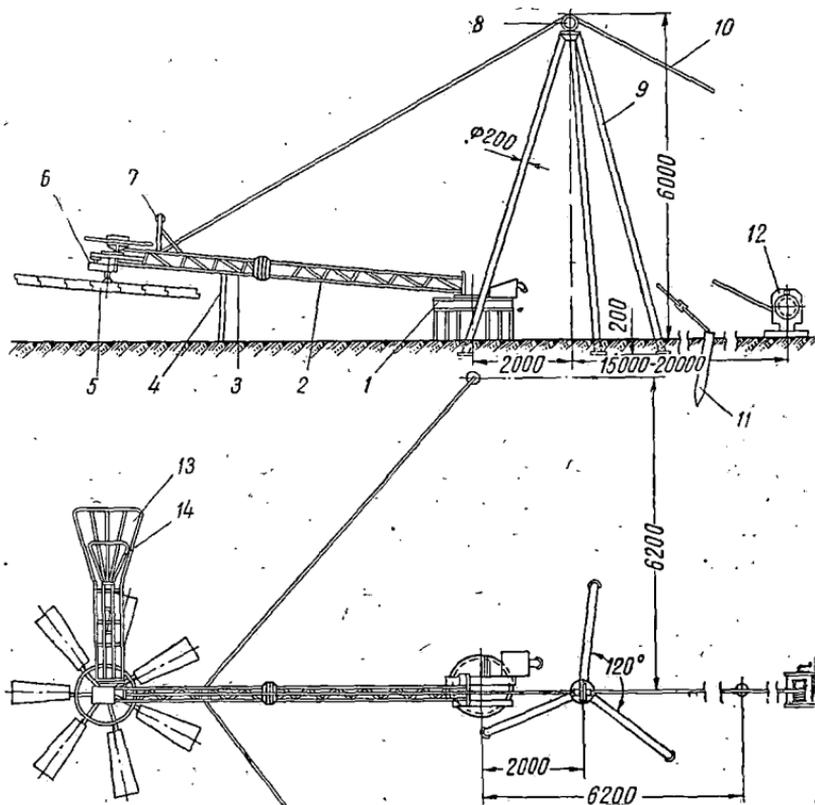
Схема оснастки ветродвигателя ДДК-4:
